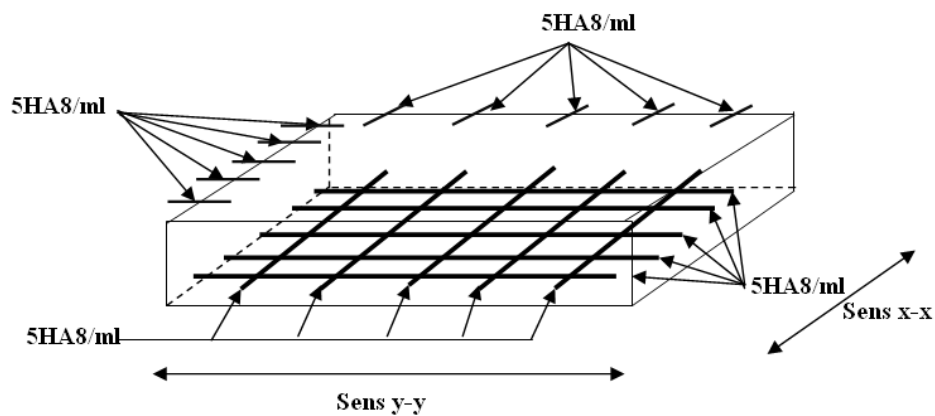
Schéma de ferrailage de la dalle pleine au-dessous de l'ascenseur
